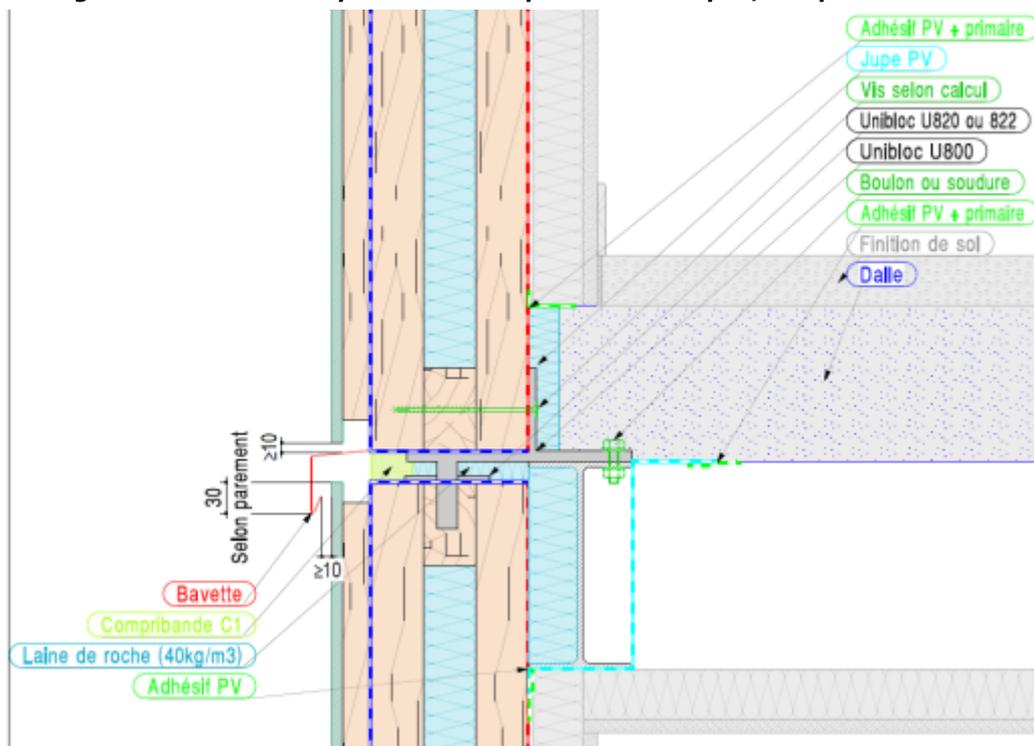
Raccord de panneaux sur profil de rive métallique / Coupe verticale
